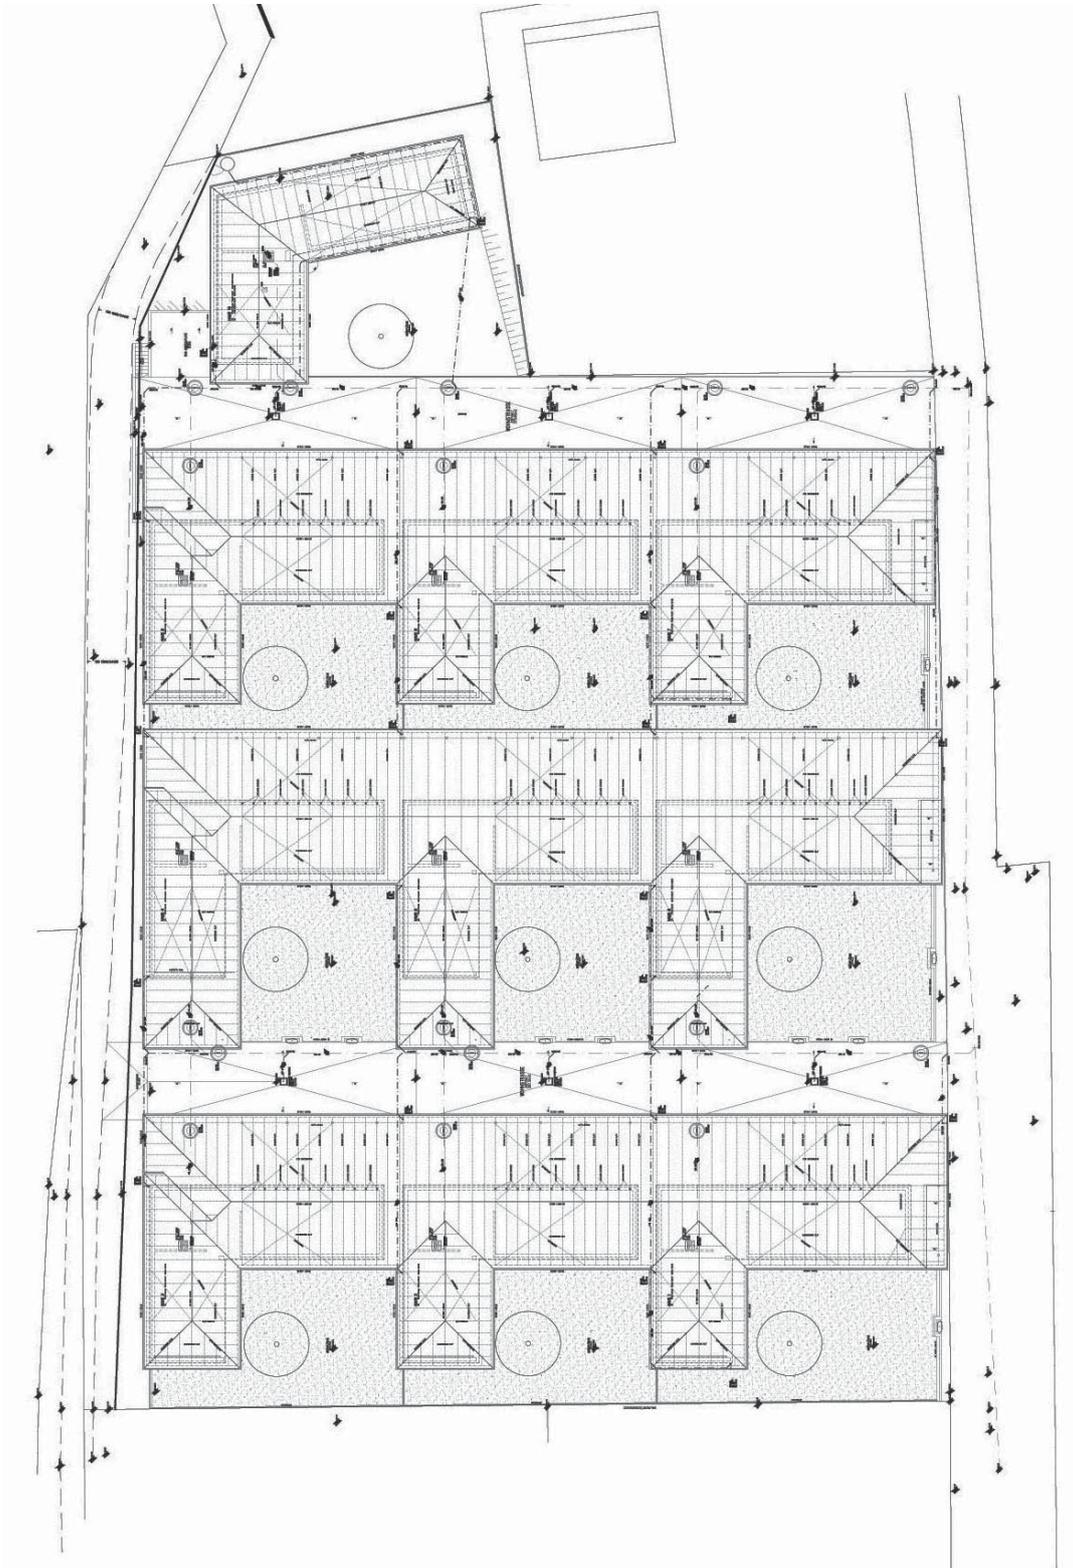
Lageplan Wohnhausanlage Egelsee, Quelle: Archiv Architekt Linsberger
